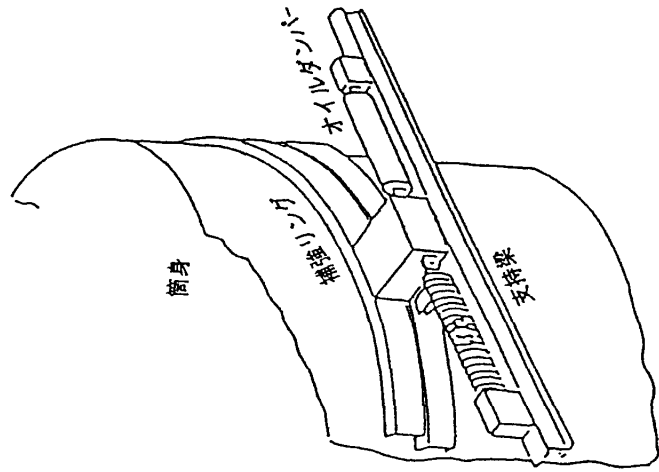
Tuned Mass Damper 連接佈置圖
